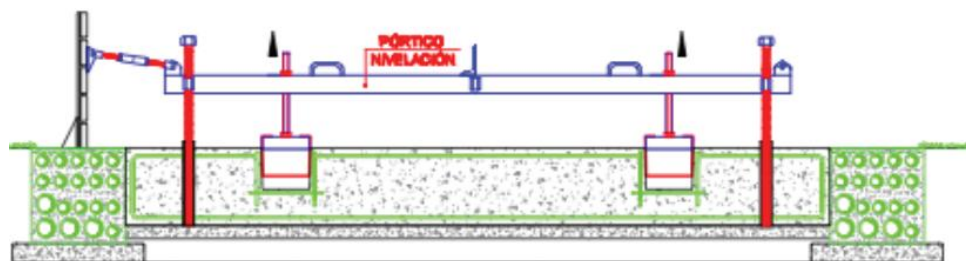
Croquis Ejecución y posicionamiento de la placa principal con acanaladuras mediante pórticos. Fuente: Adaptado de SENER
